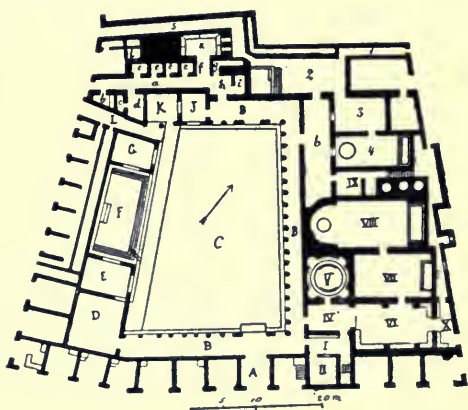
Grundriß der Stabianer Thermen. A Haupt-
